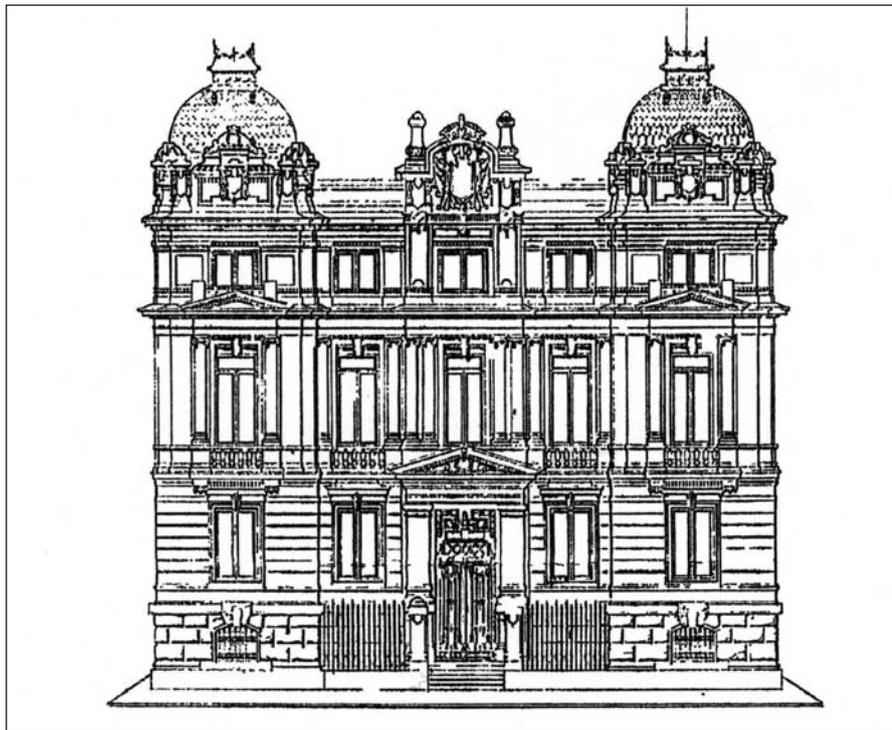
Fachada principal del proyecto de Francisco Javier de Luque, 1918 (AH.IGME).
